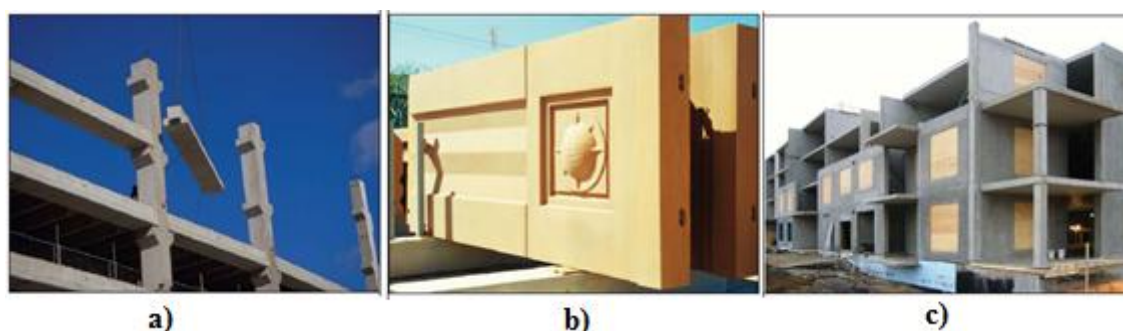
Aplicações da Prefabricação no setor da construção: a) vigas e pilares; b) painéis de fachada e c) habitações multifamiliares, [7]
